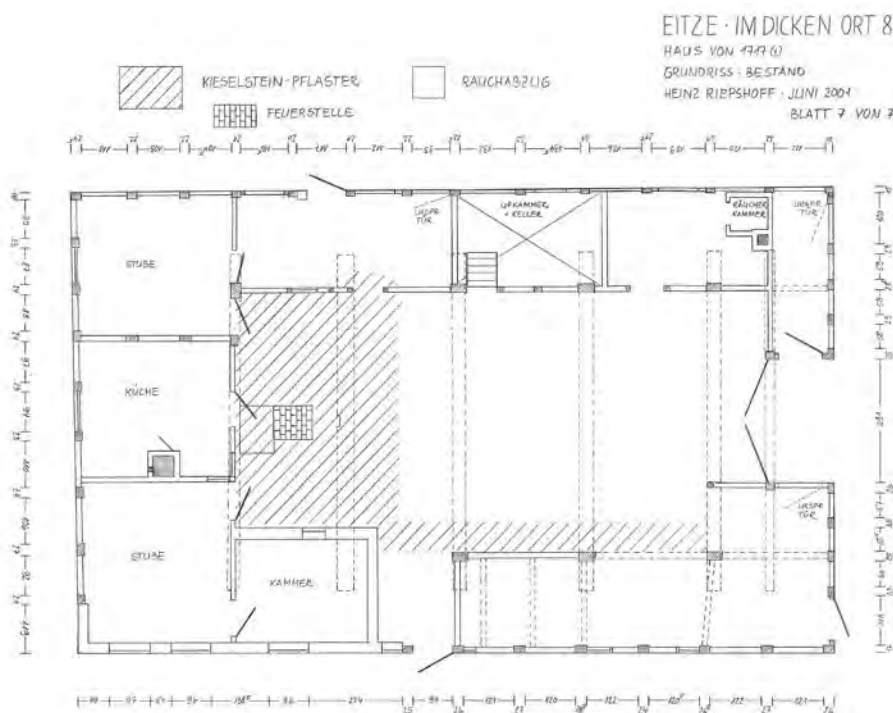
Der Grundriss zeigt den Baubestand von Eitze Nr. 9 im Jahre 2001.
